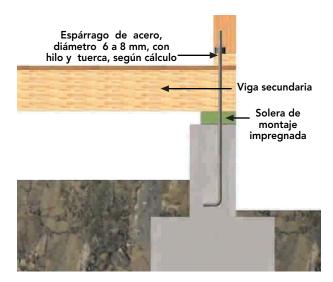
22: Viga perimetral del entramado de piso, se fija a solera de montaje en la fundación continua mediante ángulos metálicos. El tabique soportante perimetral es anclado a la fundación mediante la colocación de espárrago con hilo y tuerca (diámetro de 6 a 8 mm), aproximadamente cada 0.80 m, uniendo la solera inferior del tabique con la solera de montaje a través del espárrago anclado al sobrecimiento.
